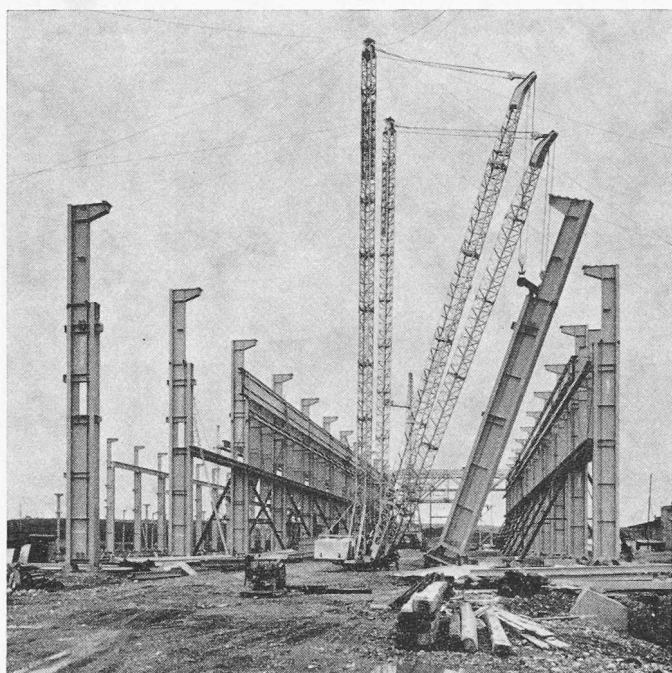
Montage einer Stütze der grossen 36-m-Halle
